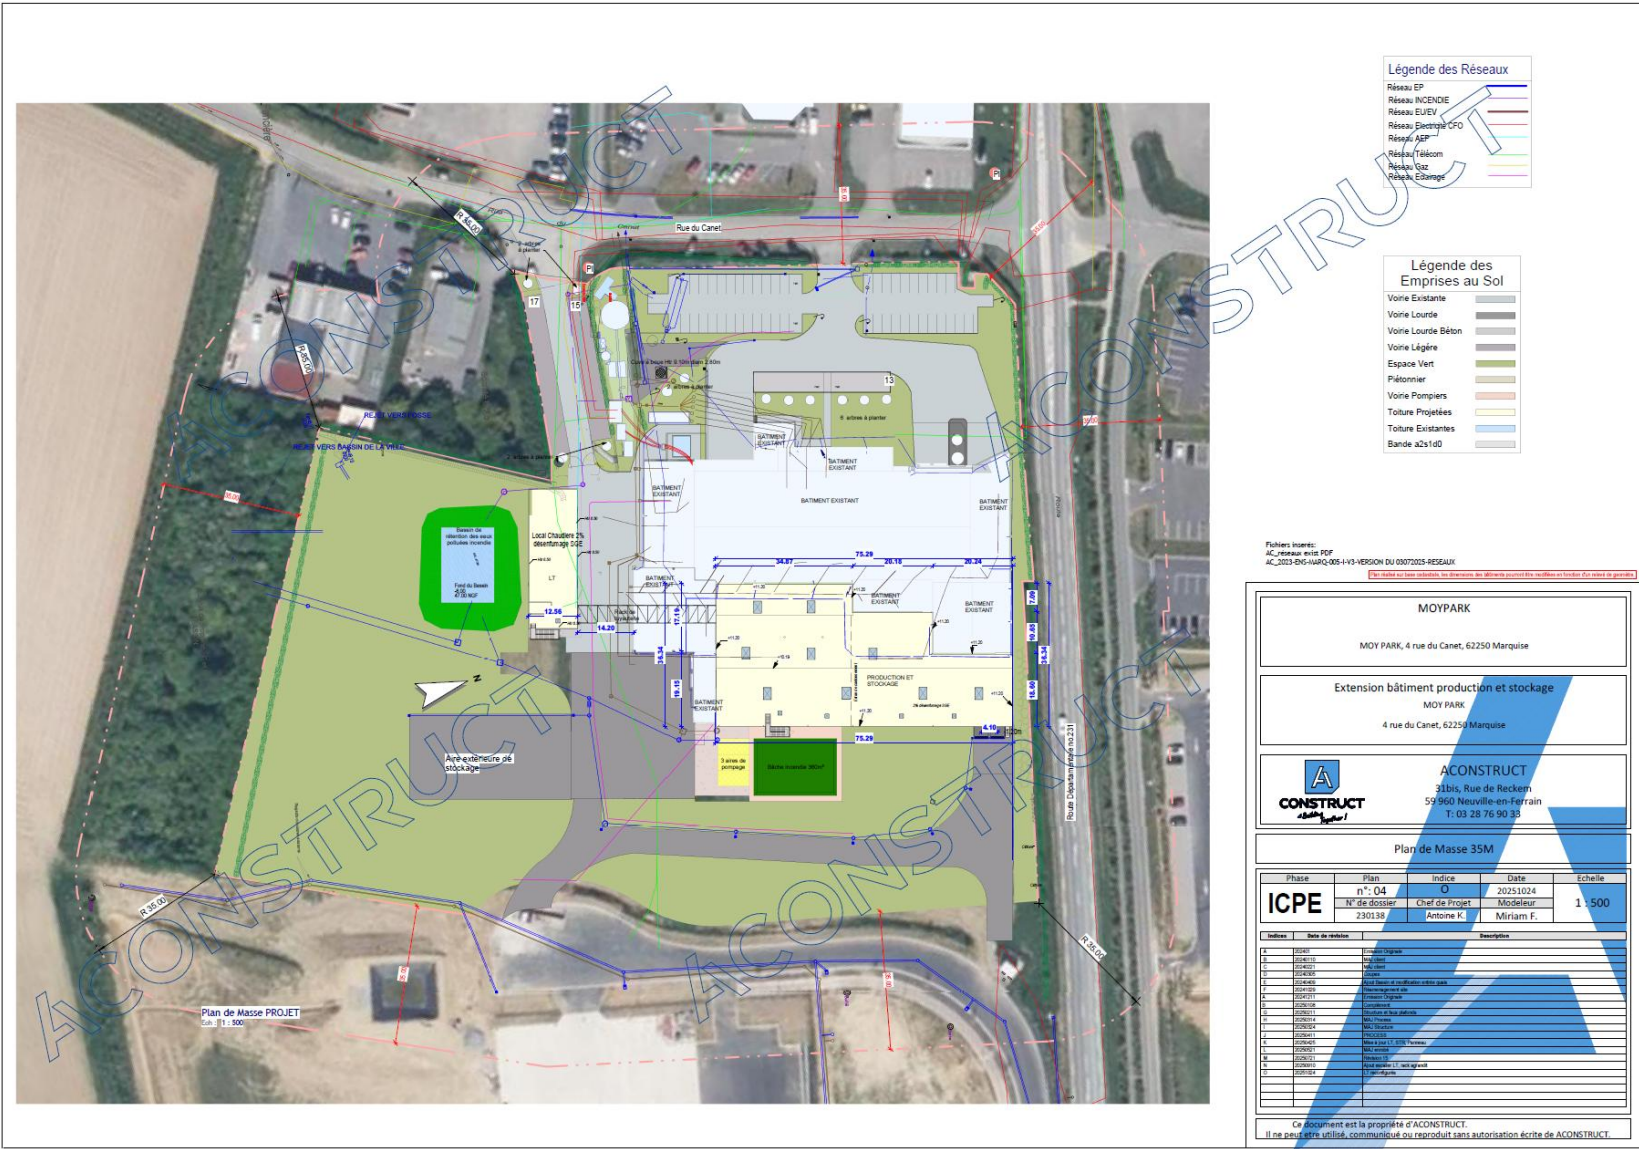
Plan de masse et des réseaux du projet (Source : AConstruct)
